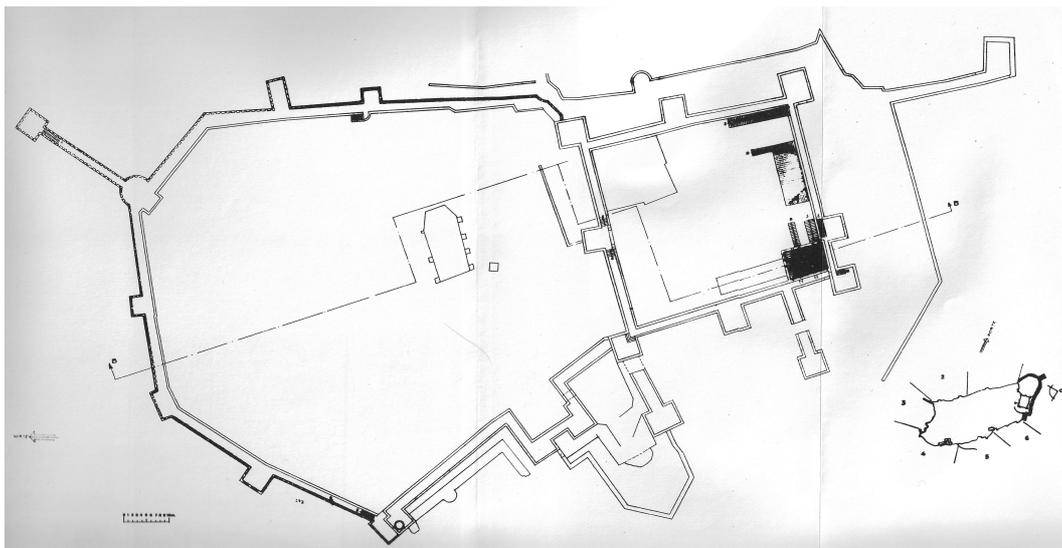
Castillo de Trujillo, Grundriss
